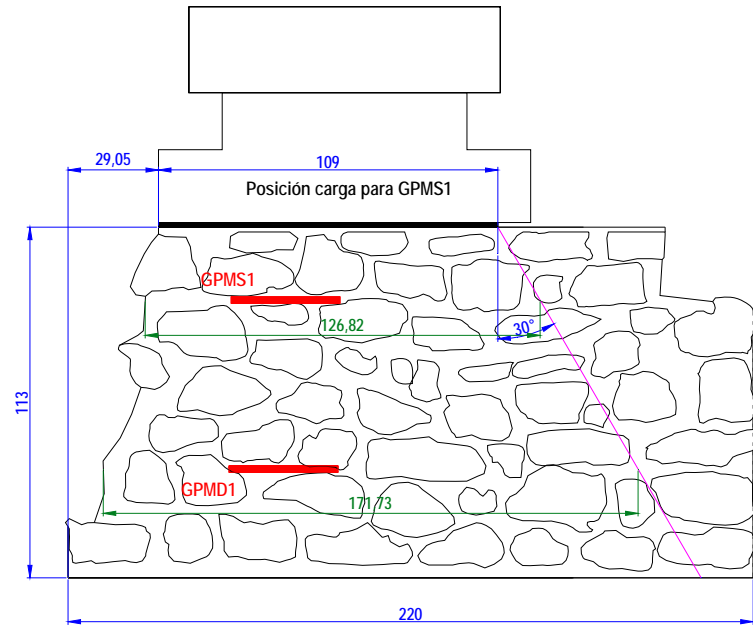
Ubicación del ensayo de gato plano simple GPMS1 (el emplazado en la parte superior) y del de gato plano doble GPMD1 en el alzado del muro de mampostería. Las cotas relacionadas están en cm.
